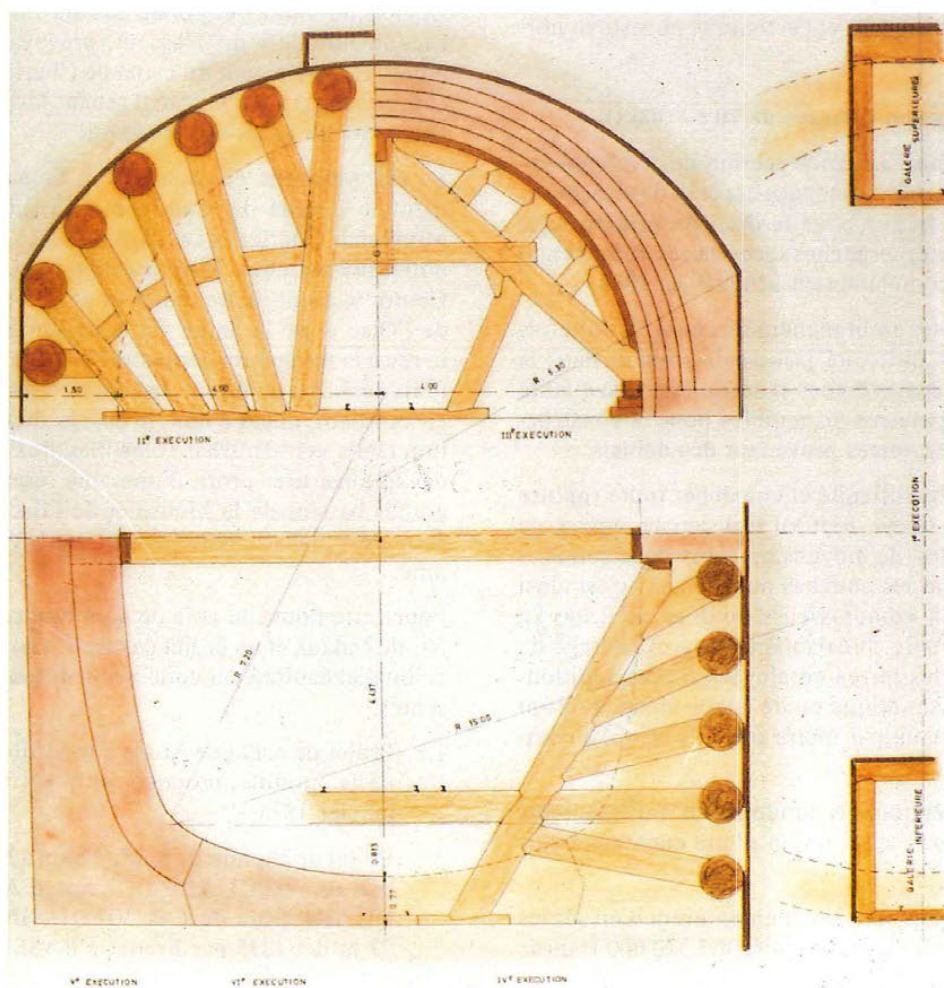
Blindage et construction du souterrain pour bateaux de 300 t.
